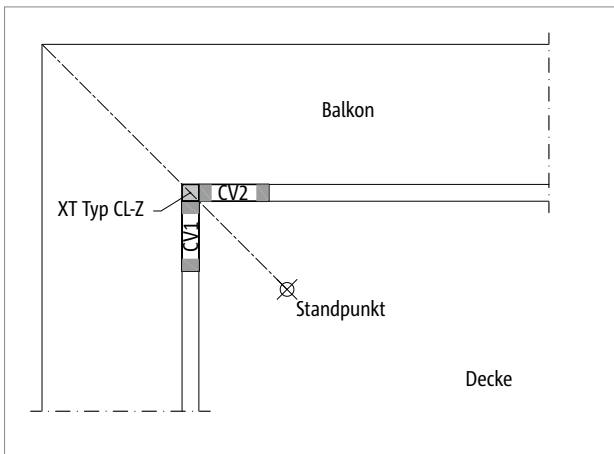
Schöck Isokorb® XT Typ CL: Betondeckung wählbar: Hier CV1 links vom Standpunkt, Betondeckung CV2 rechts vom Standpunkt
